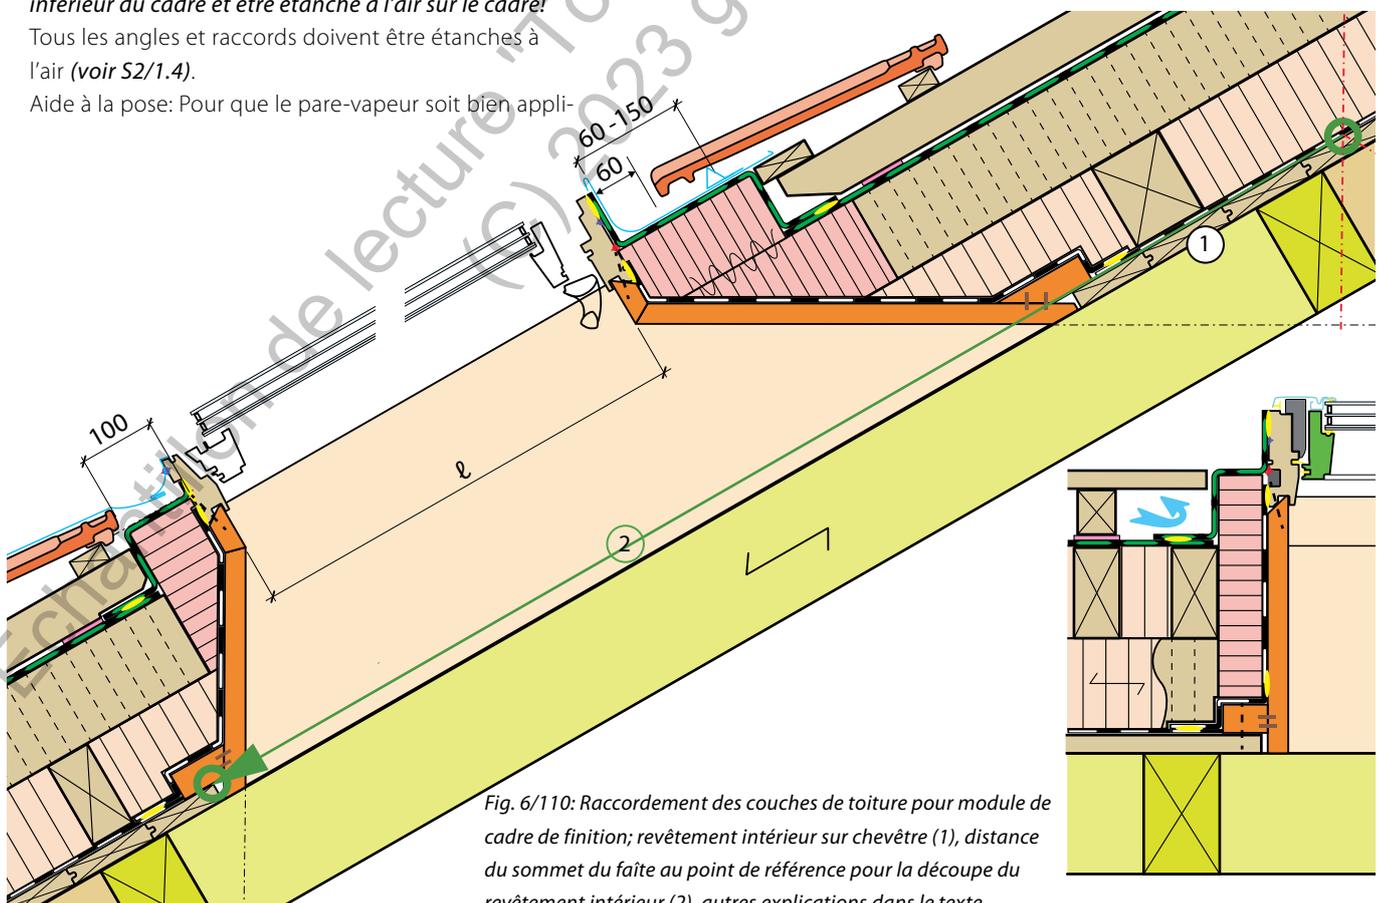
/110: Raccordement des couches de toiture pour module de cadre de finition; revêtement intérieur sur chevêtre (1), distance du sommet du faite au point de référence pour la découpe du revêtement intérieur (2), autres explications dans le texte
